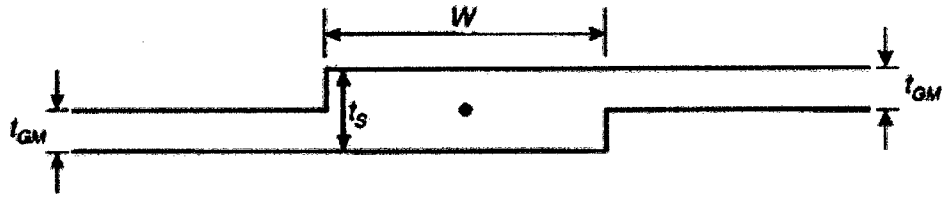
Soldaduras utilizadas en Geomembranas.
